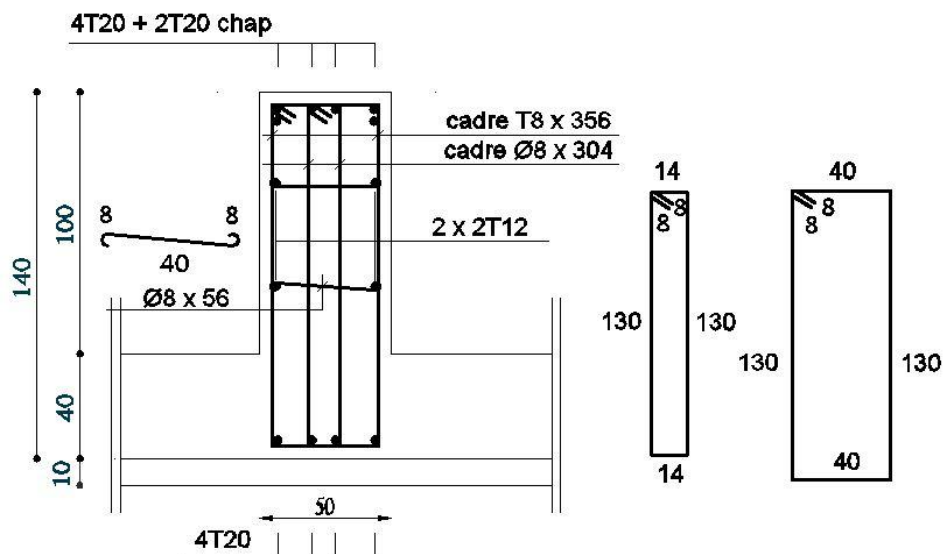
dessin de ferrailage d'une poutre principale en travée.
